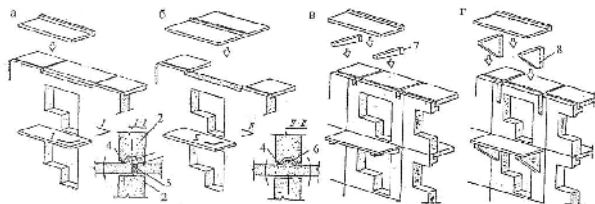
Схемы передачи изгибающего момента и вертикальных усилий от балконной плиты на конструкцию: а — наружной несущей стены; б — железобетонной панели перекрытия (в наружной стене); в — железобетонной панели перекрытия; г — кирпичной стены; 1 — балочная плита; 2 — наружная стена; 3 — перекрытие; 4 — термотит; 5 — утеплитель; 6 — противоокаевой гребень; 7 — консоль; 8 — кирпичная стена
